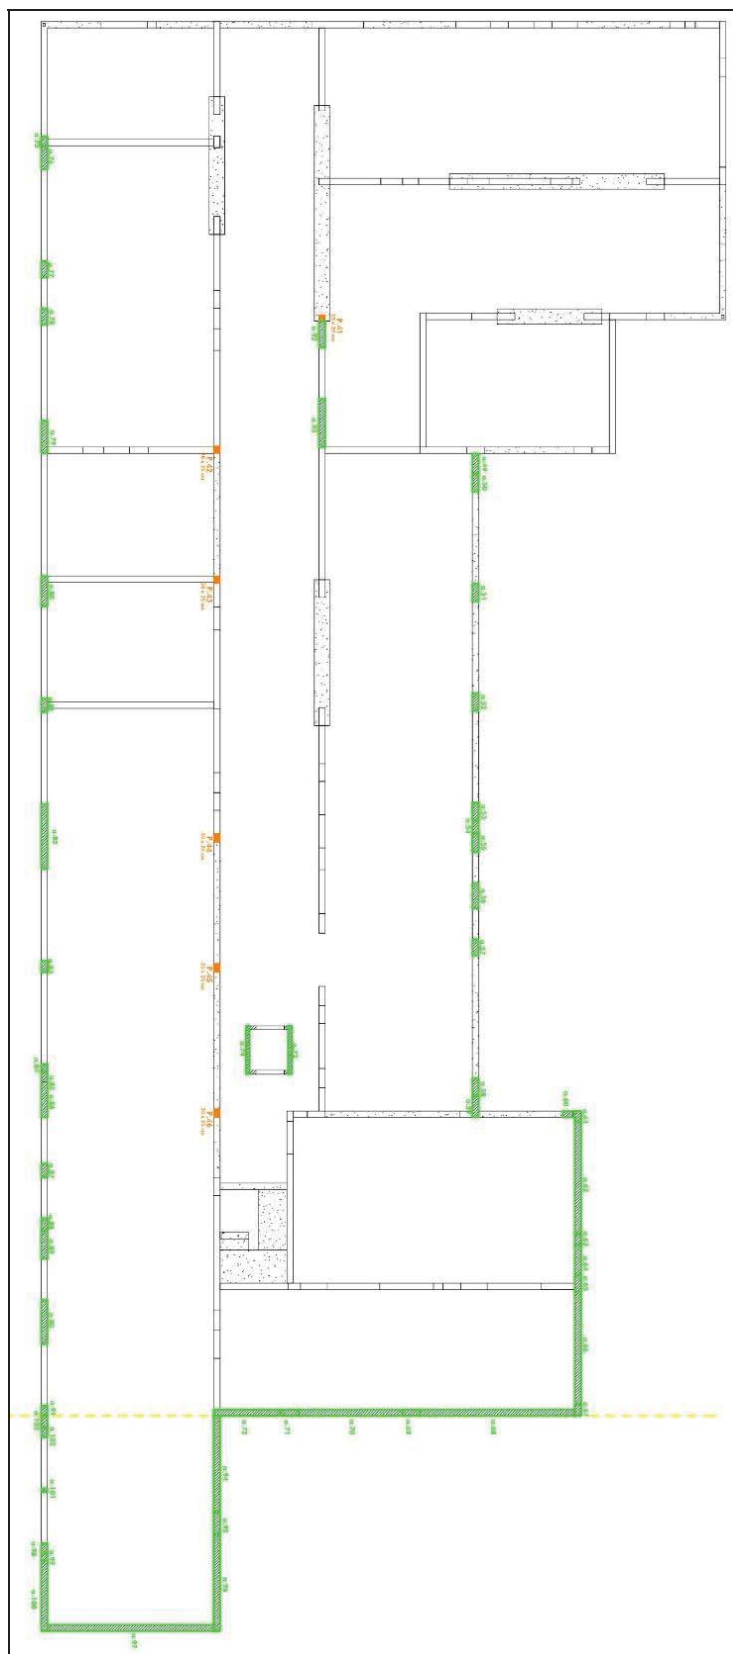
Pianta strutturale del piano primo, includente la numerazione dei setti in verde e dei pilastri in arancione
